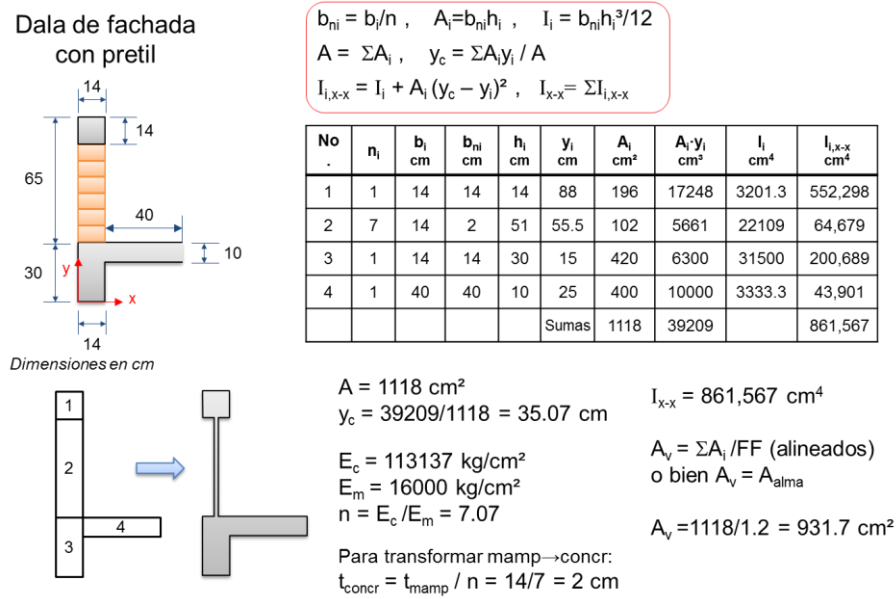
Modelado de losas con vigas o dalas y/o pretilles
